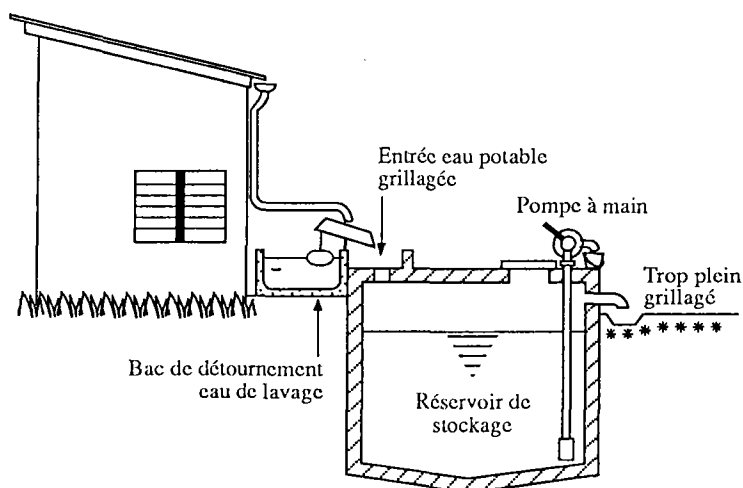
Récupération des eaux de pluie sur la toiture d'une maison et stockage dans un réservoir ferrociment enterré.
